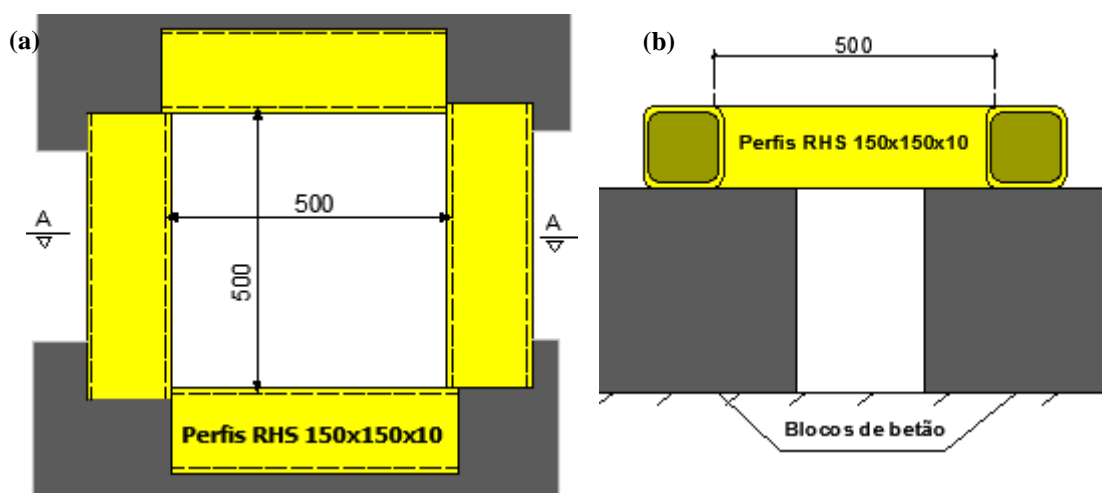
Sistema de apoio dos painéis em perfis RHS, (a) vista em planta e (b) vista pelo corte A-A, (desenho sem escala e dimensões em mm).
